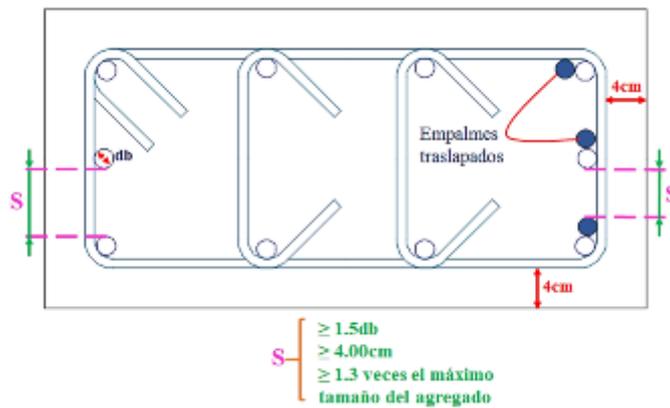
Espaciamientos mínimos de armaduras en columnas.
